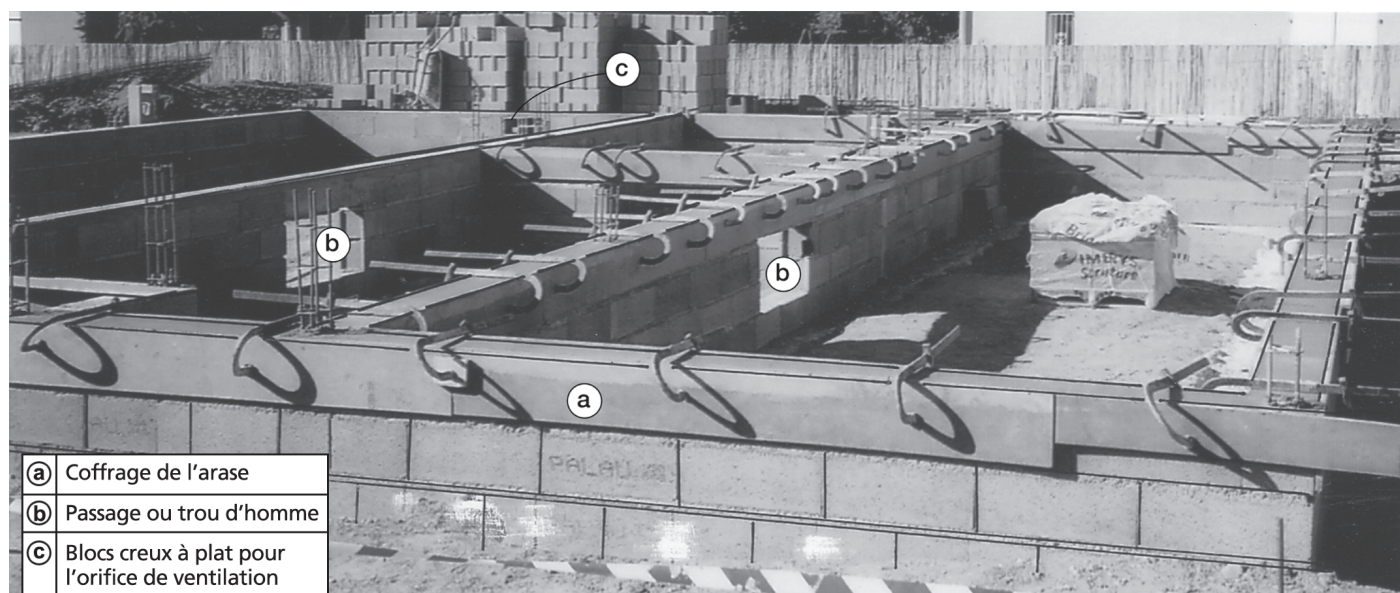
Réalisation d'un soubassement pour un plancher sur vide sanitaire ventilé
